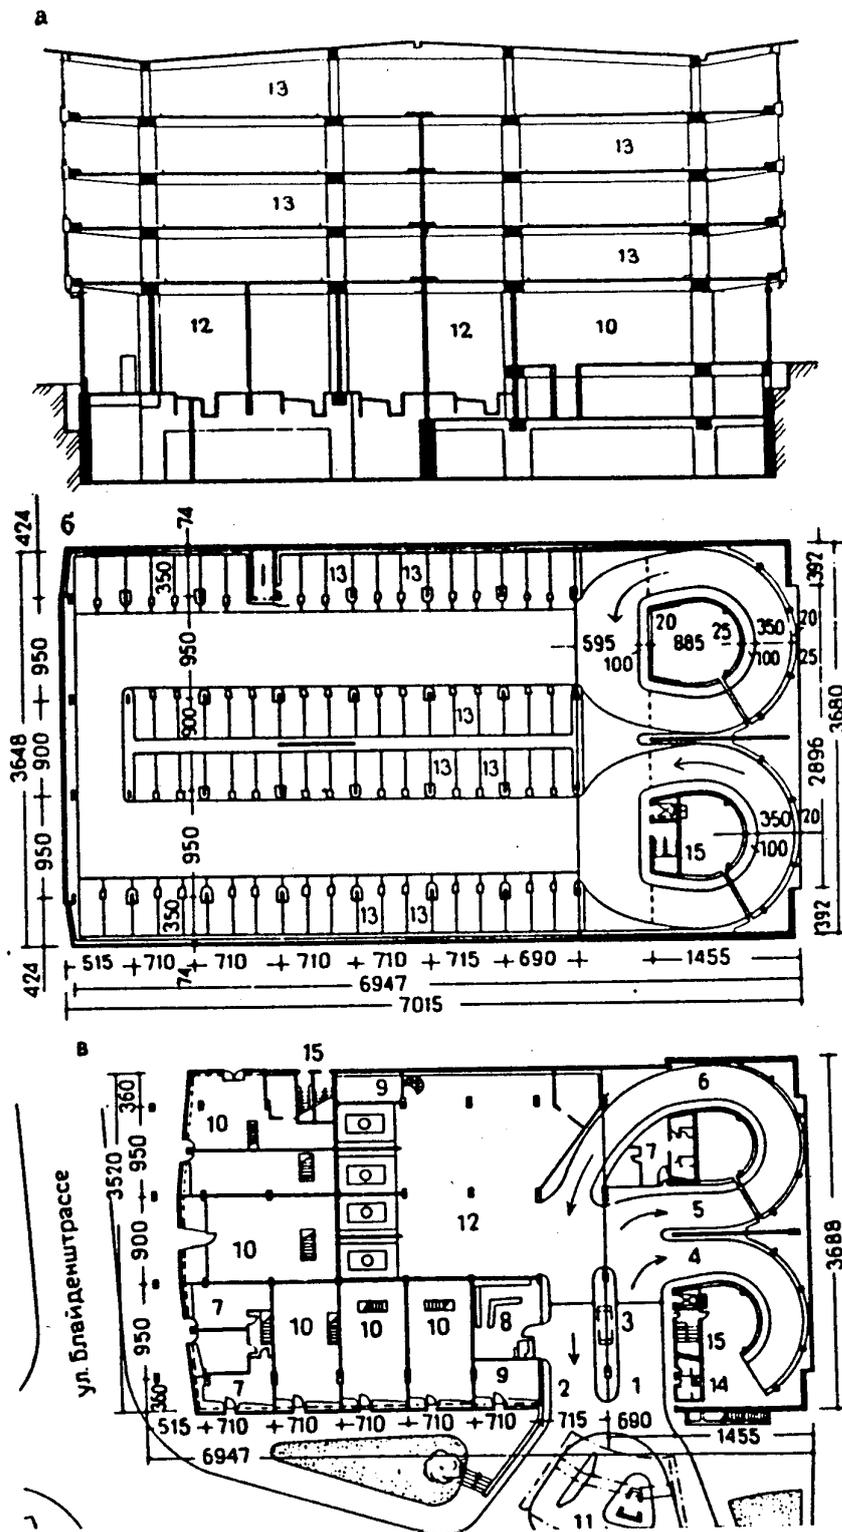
Гараж "Гаупт-Вахе" во Франкфурте-на-Майне, ФРГ. Арх. Х.Ромейк, инж. М.Майд. Поперечный разрез (а). План типового этажа (б). План 1-го этажа (в)
